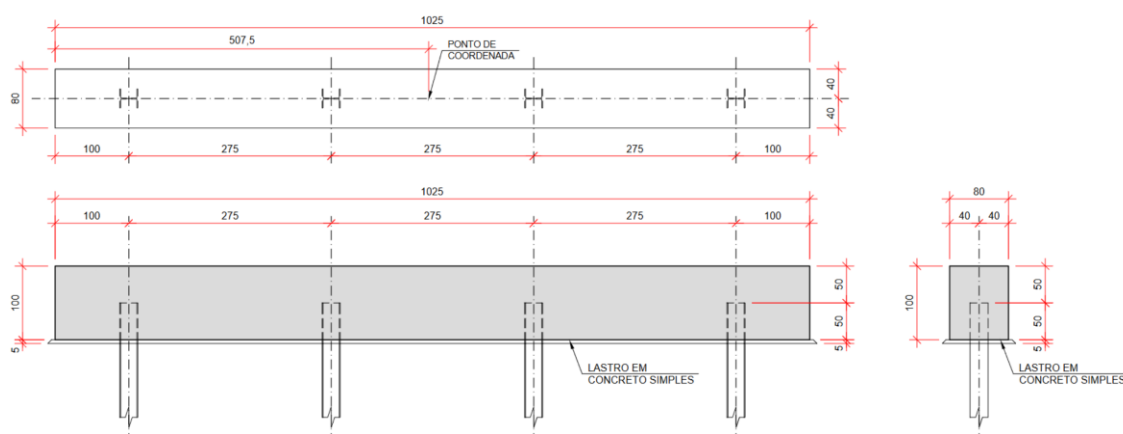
RAMO 400 - DISTRIBUIÇÃO DAS ESTRUTURAS DE FUNDAÇÃO (EIXOS E12 AO E18)
